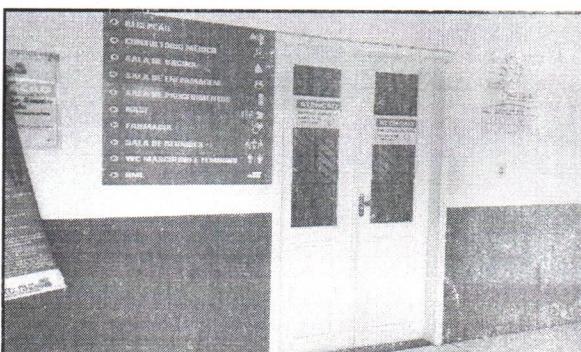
Vista da Esquadria em madeira para acesso a Recepção
